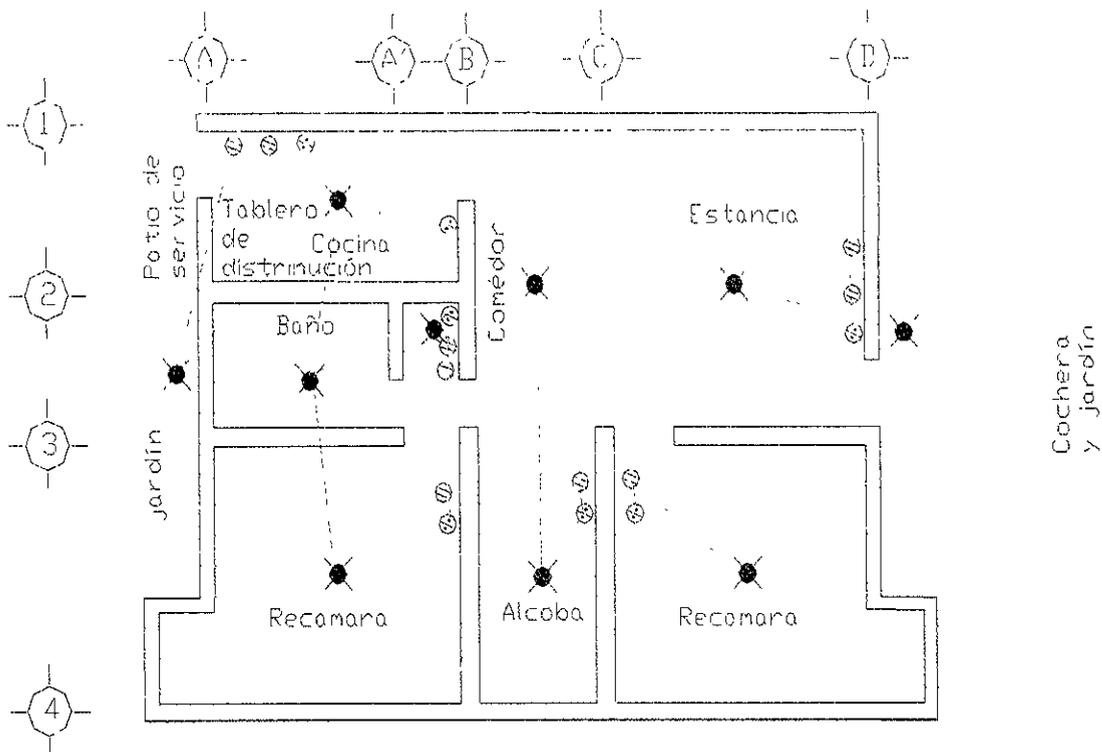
Distribución de ductos en azotea para instalación eléctrica.
